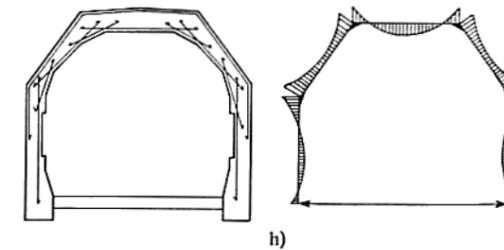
Tunnelrahmen aus bewehrtem Beton.
